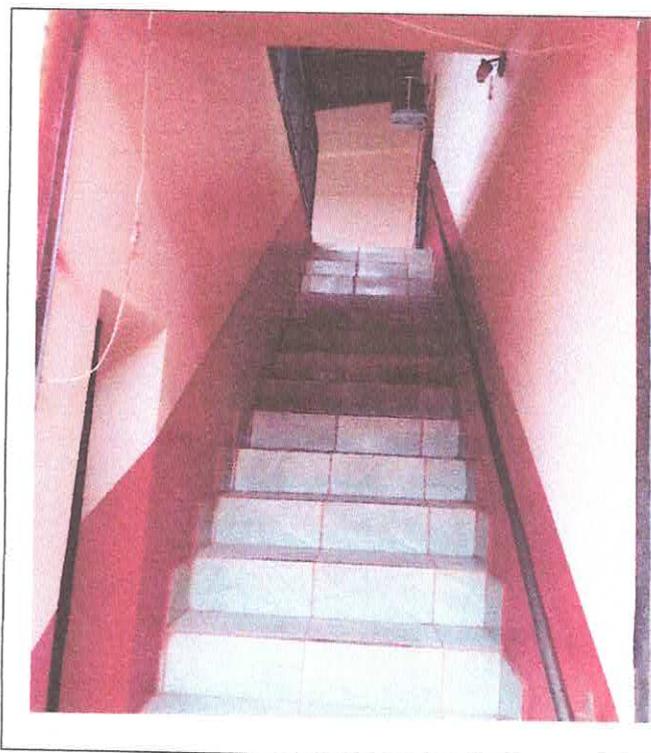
FOTO DA ESCADA DE ACESSO DO IMÓVEL
